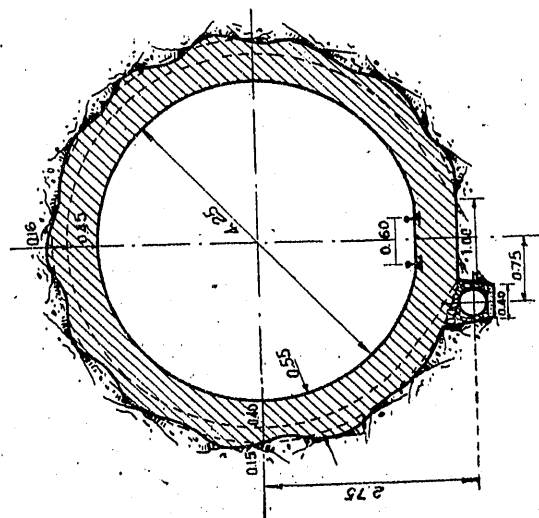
^a — Secciones tipo de la galería forzada principal.
